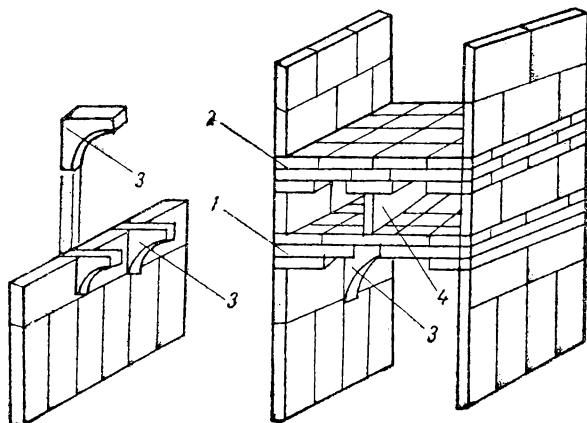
Executarea bolților la sobele de dimensiuni mari:
